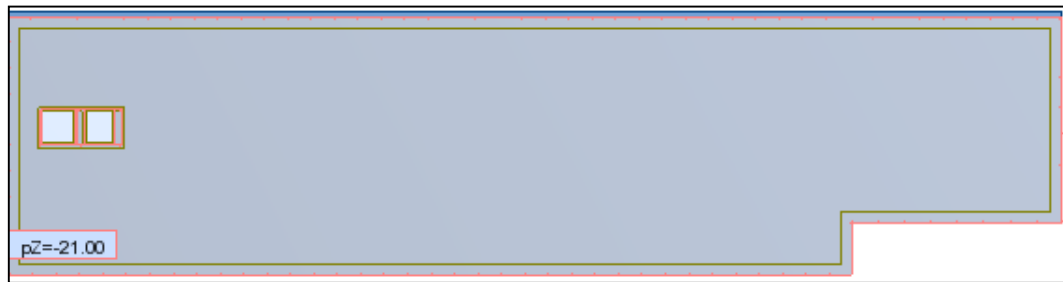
Plan des charges permanentes sur la dalle de couverture
